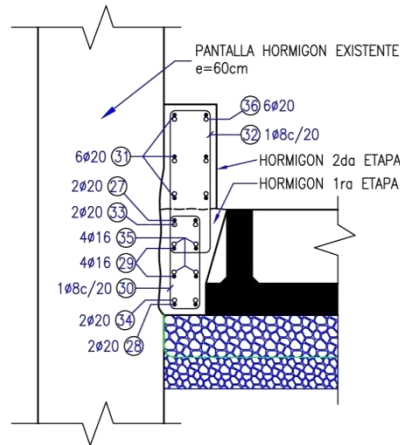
Picado de bordes para la posterior construcción de viga de fricción
